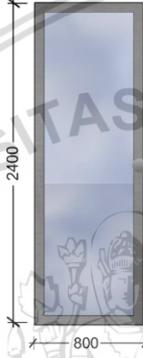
81 Denah kode jendela alternatif desain pada ruang tengah
